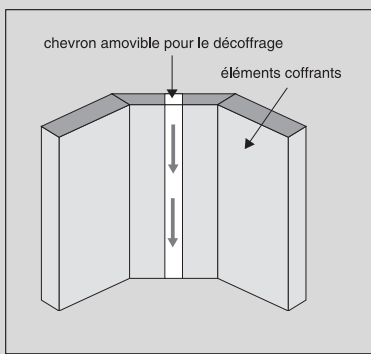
Coffrage intérieur sur toute la hauteur du réservoir ou couissant (plusieurs passes).
